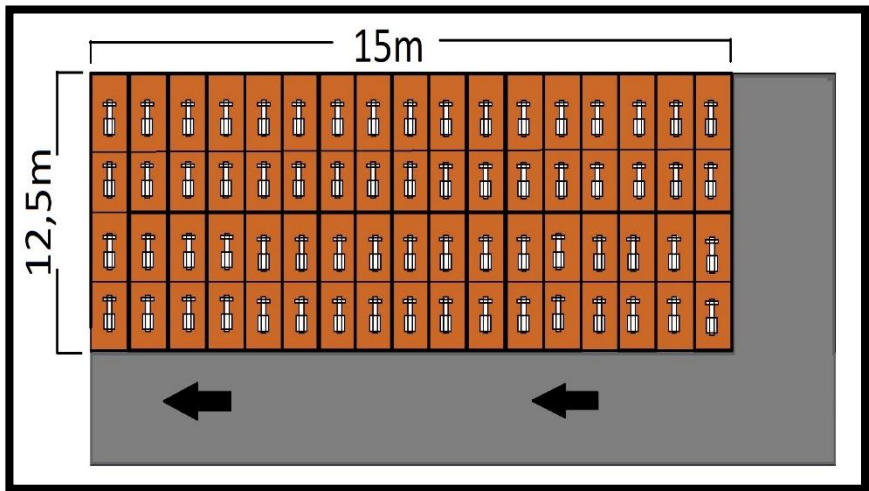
Ruang parkir A Pasar Srimangunan Sampang
